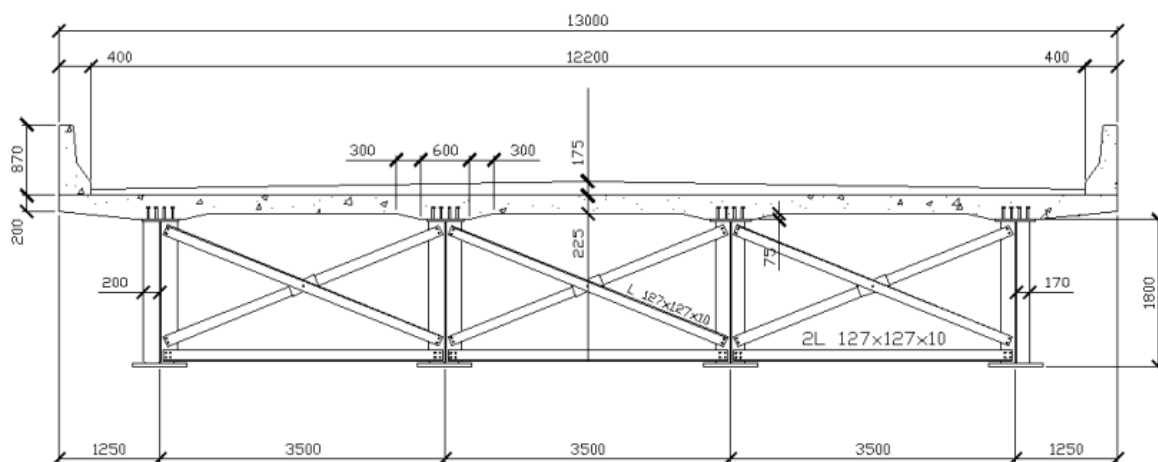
Seção transversal no meio do vão da ponte em vigas mista (adaptado de BELLEI e PINHO, 2007). Dimensões em mm.
